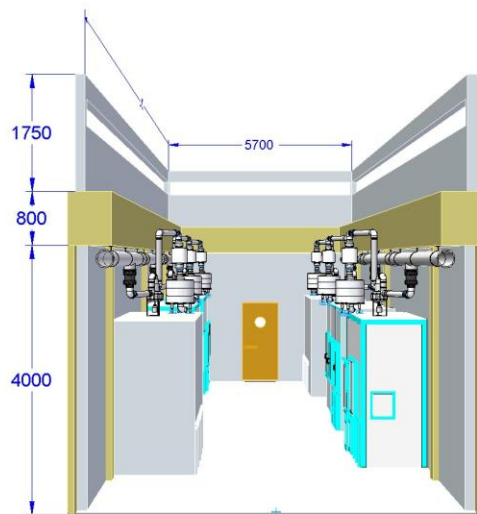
Desenho representativo ALA QUENTE 2 com dimensões
